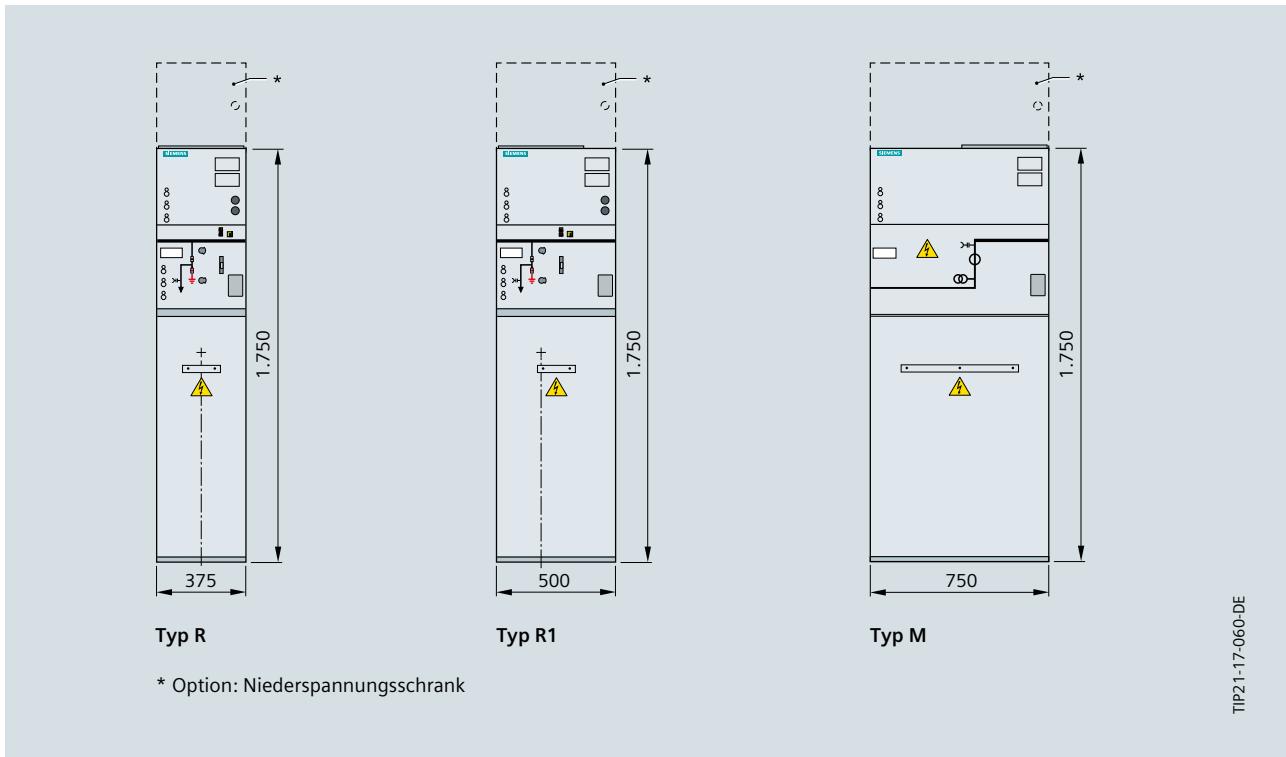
/6: Frontansichten für Schaltfelder SIMOSEC (Typ R, R1 und M als Beispiele für die Breiten 375 mm, 500 mm und 750 mm; Maße in mm)
